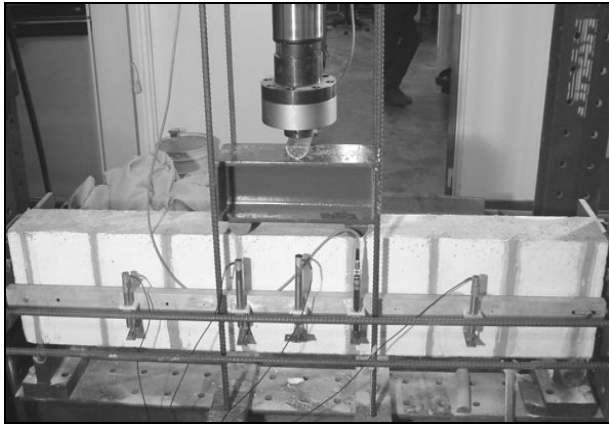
Esquema geral do ensaio das vigas da série A (dimensões em mm).
